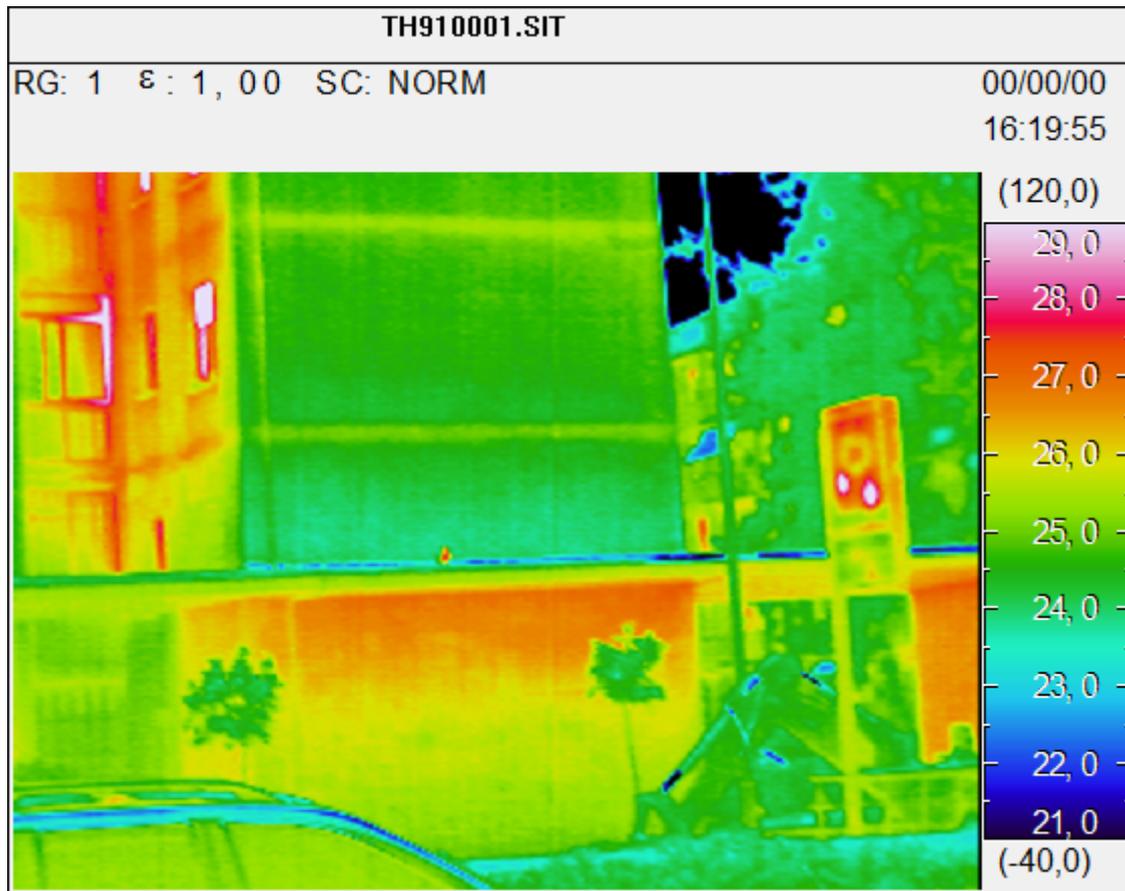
Fachada Norte 16 horas, mes de Julio.
